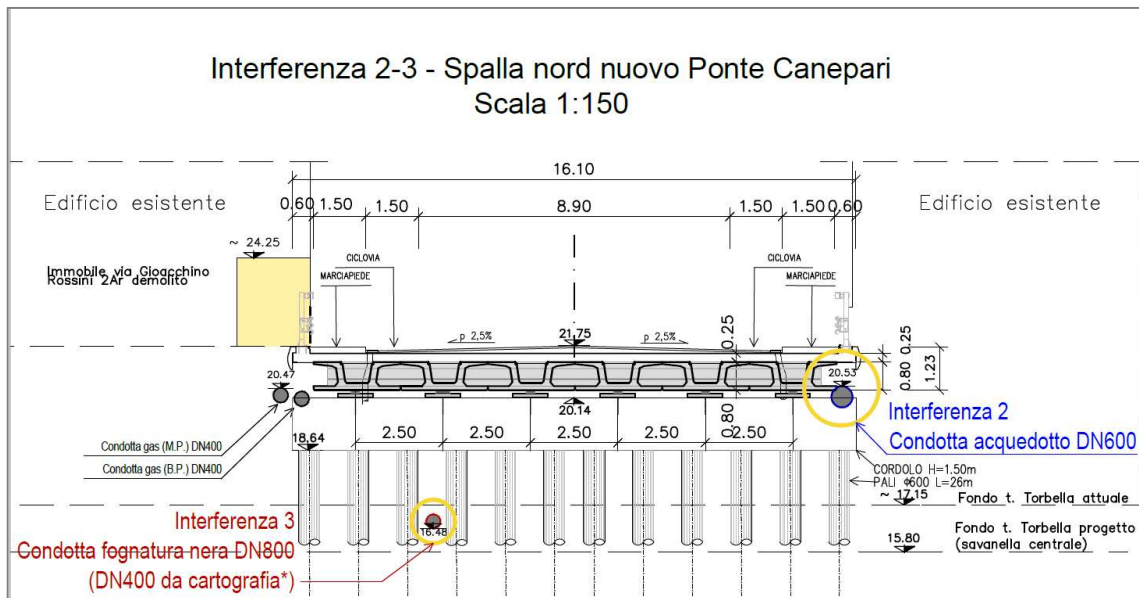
Sezione trasversale del nuovo ponte di via Canepari in corrispondenza della spalla nord (evidenza dell'interferenza 2)
